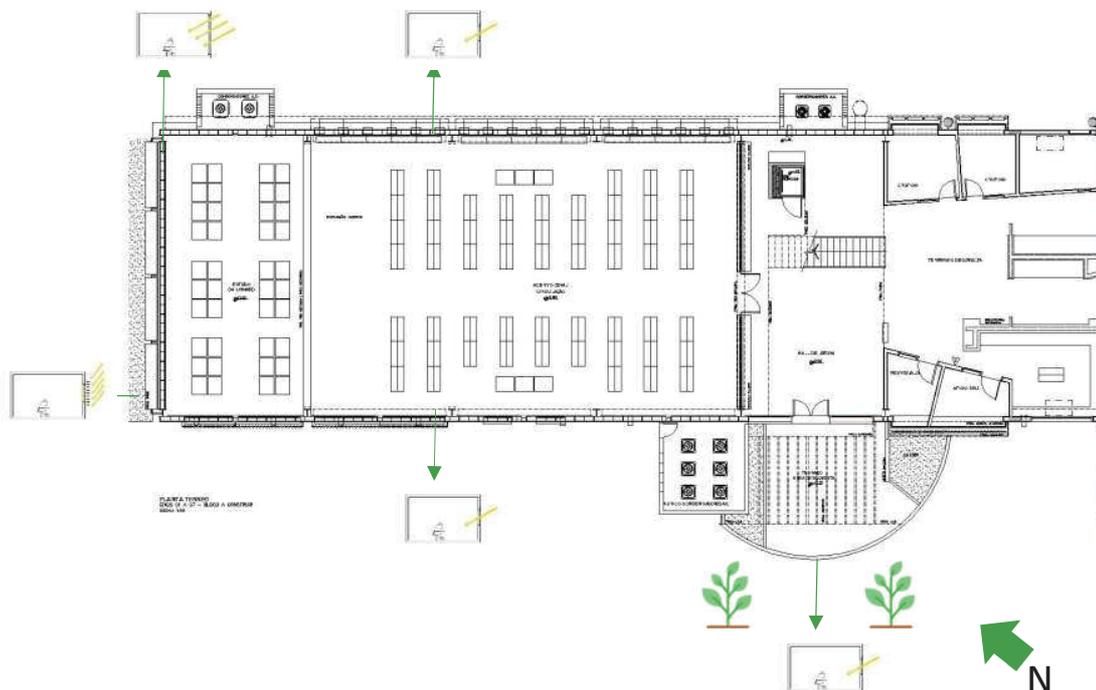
Planta Térreo Biblioteca CEDOC. Fonte: Adaptado dos Arquivos Bloch Arquitetos, 2016
